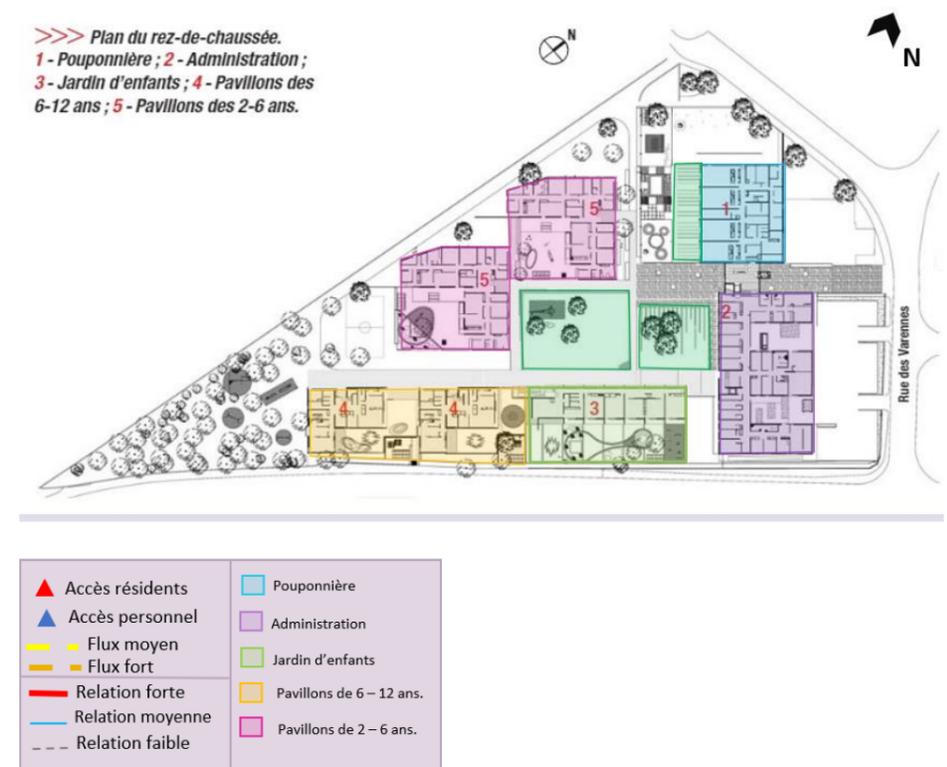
Plan d'assemblage «Sucy-en-Brieé»¹⁰¹
